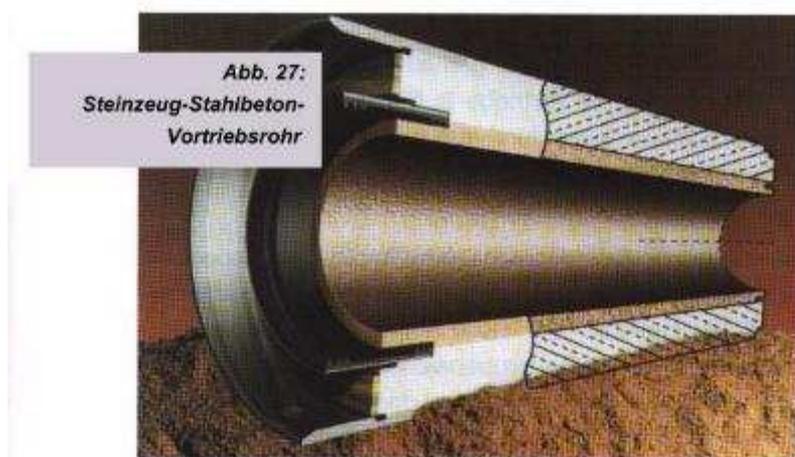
zeigt ein solches Steinzeug-Stahlbeton-Vortriebsrohr DN 400/Außendurchmesser 860 mm.
